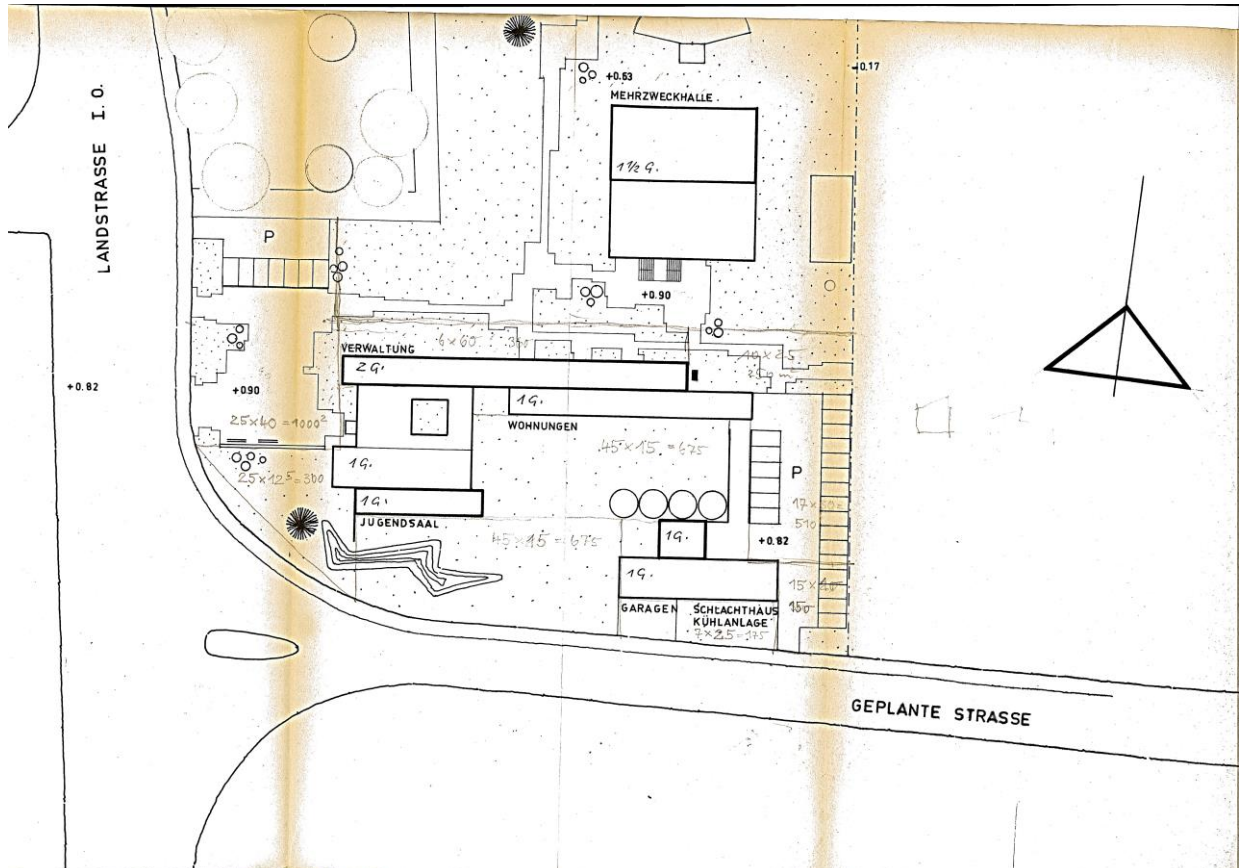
Lageplan, Quelle Ausführungsplanung Dorfgemeinschaftshaus 1963
